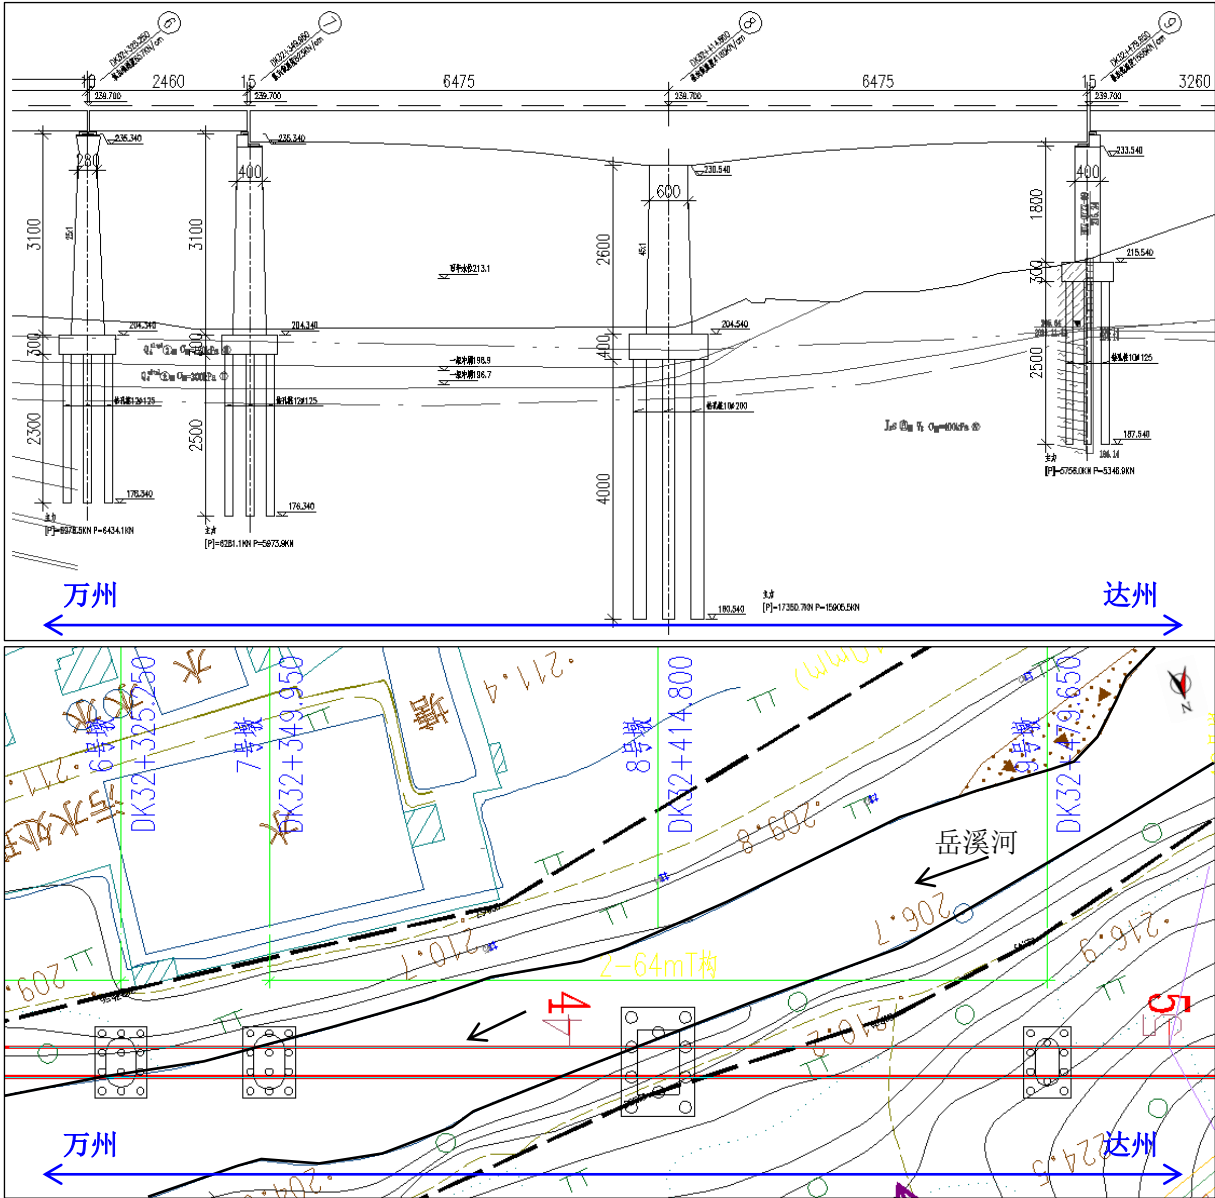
岳溪河特大桥桥台立面、平面布置示意图
